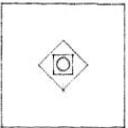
8 Sketsa dan Layout Ruang H
